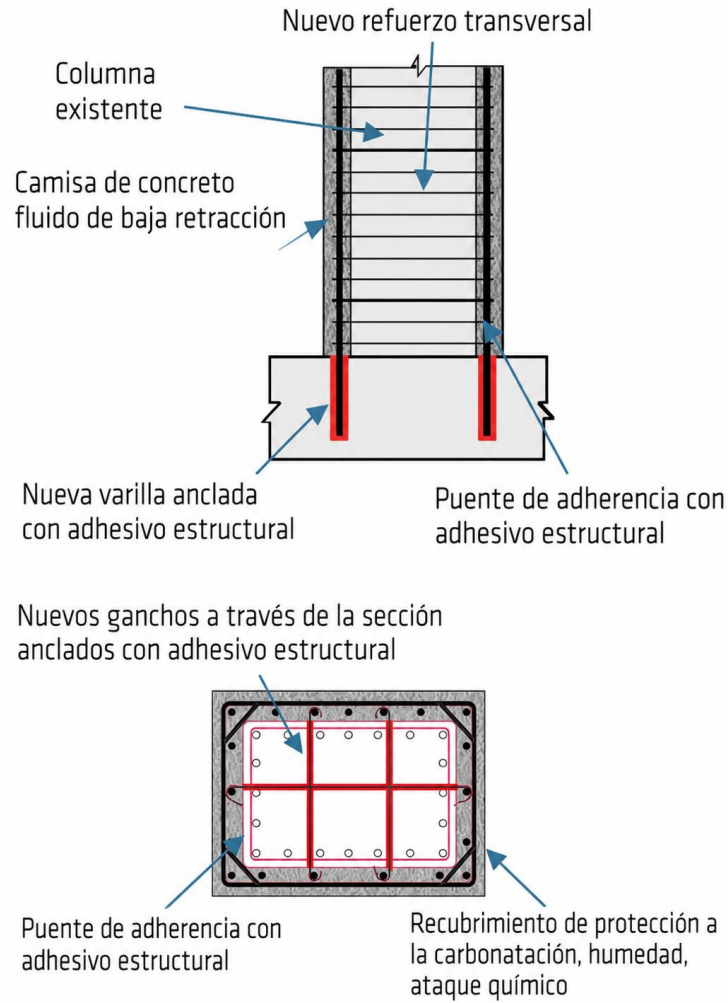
Detalle Refuerzo estructural. Fuente: Sika Colombia S.A.S. Cuarta Edición
